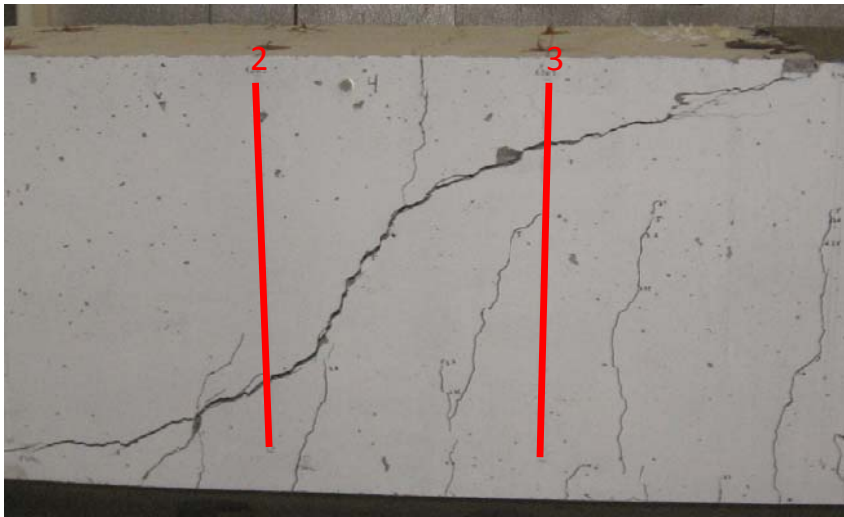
Position des barres de renforcement #2 et #3 de la dalle 3Ba, face sud
